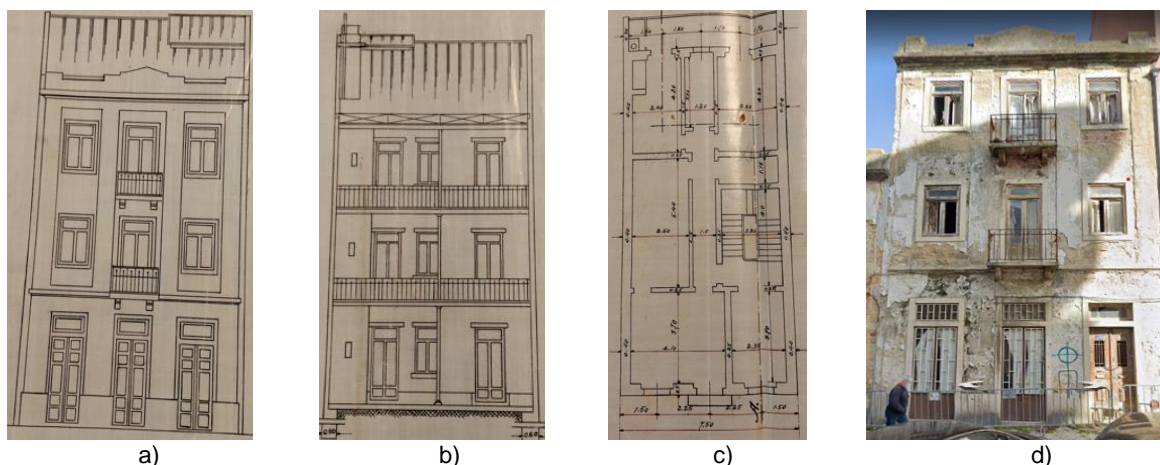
Edifício da rua Augusto Gil n.º 24: a) fachada principal; b) fachada tardoz; c) planta do 2.º andar e d) imagem atual do edifício (Google Earth, junho 2022)
